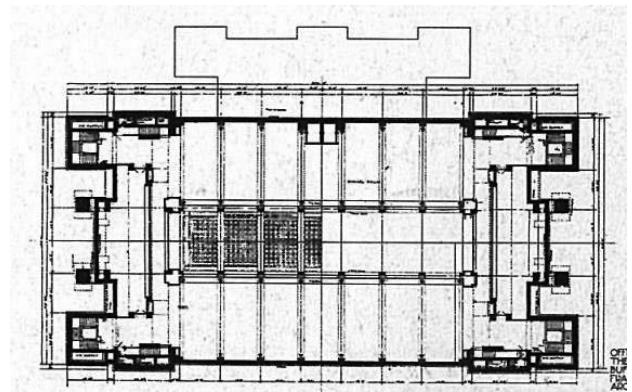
Planta do quinto piso, onde se situavam o restaurante e o jardim coberto Larkin Building, pátios.
